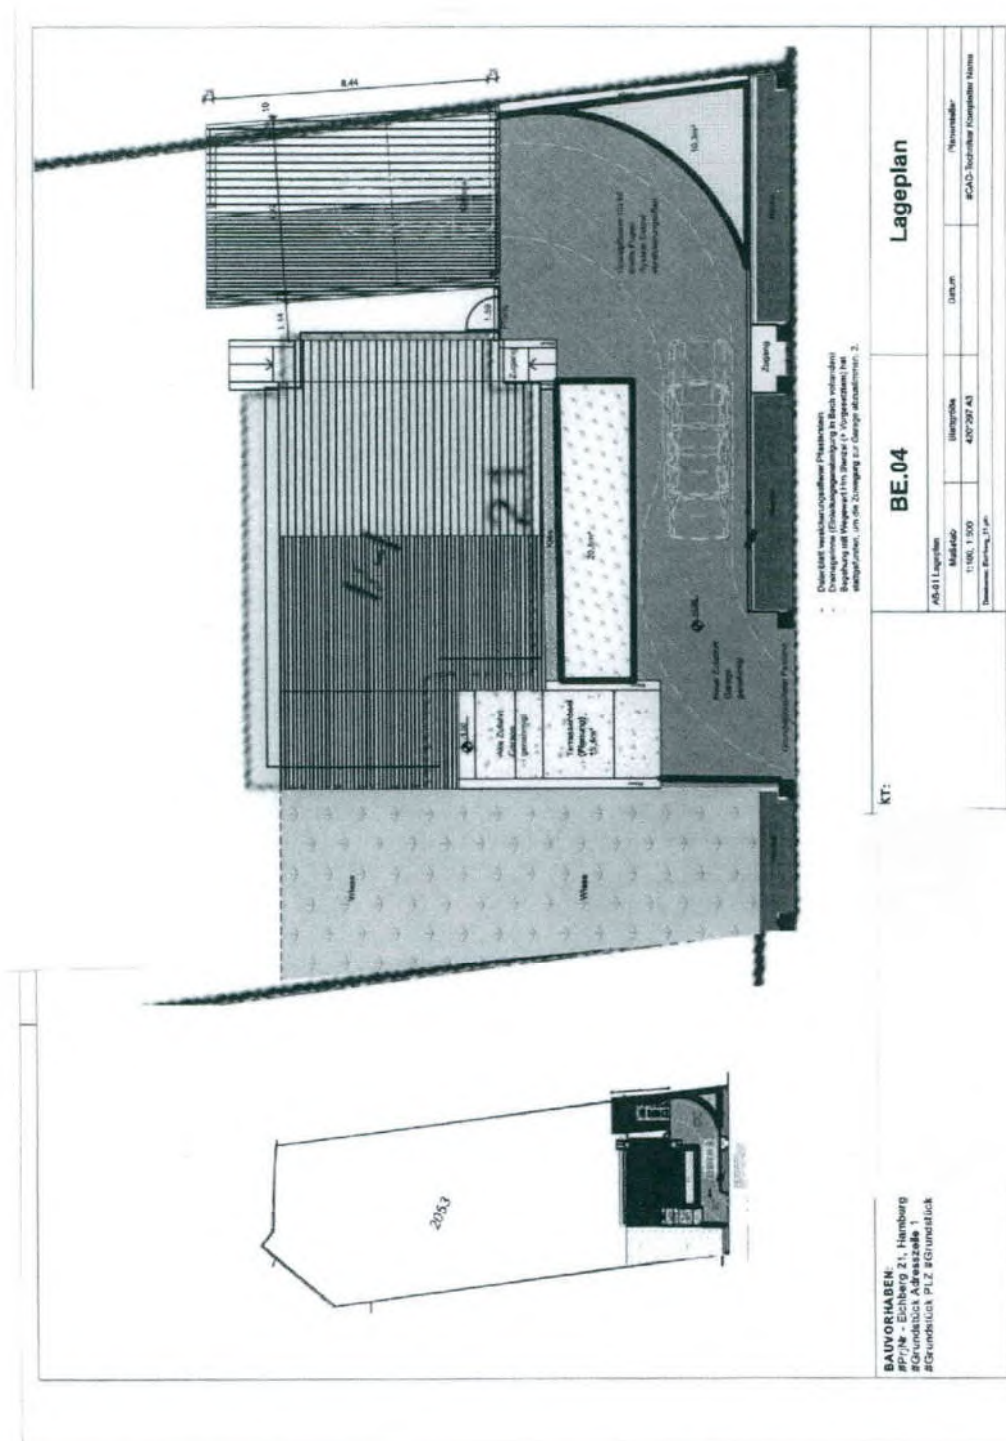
Lageplan Wohnhaus / Garagengebäude 2020
